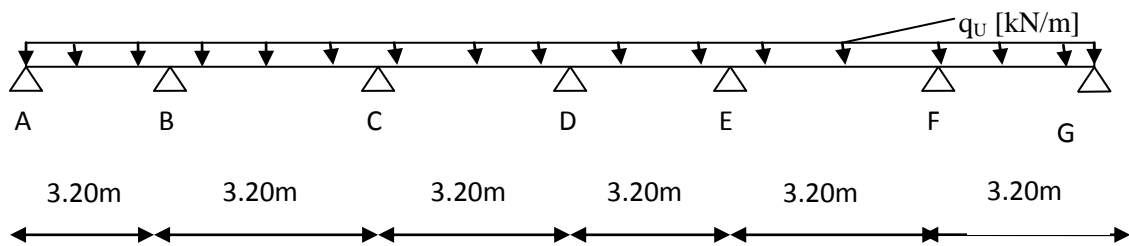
Schéma statique de la poutre continue reposant sur 07 appuis
